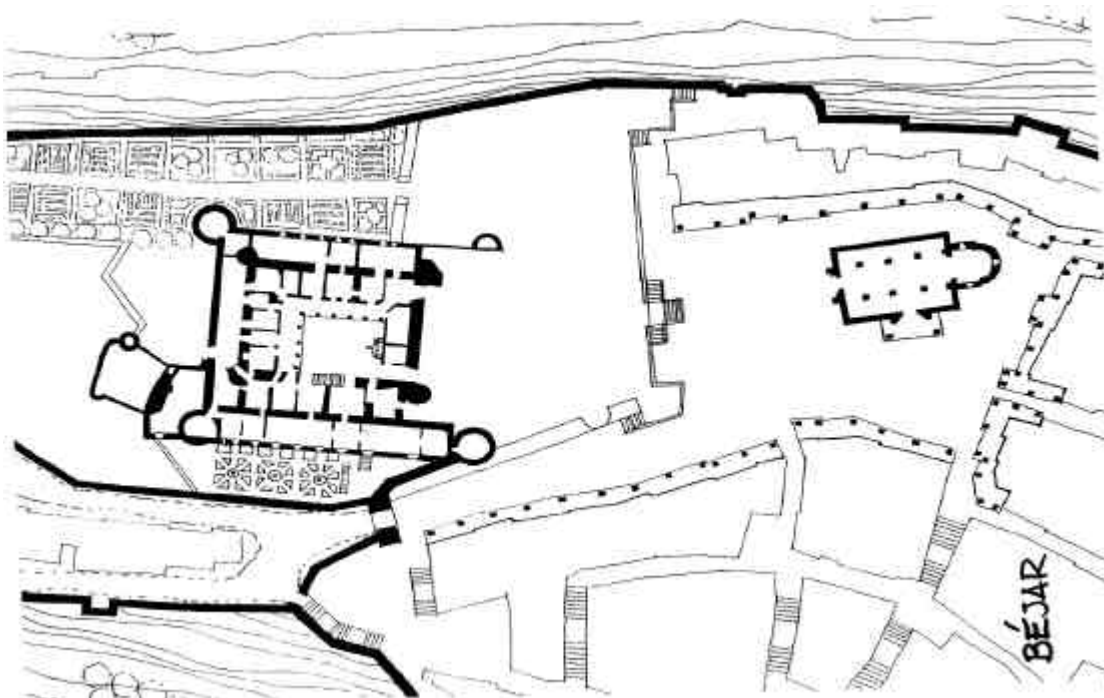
Planta general de Béjar. Reconstrucción ideal de los recintos amurallados, de sus puertas y del conjunto palacial (palacio - jardines - plaza ducal porticada).
